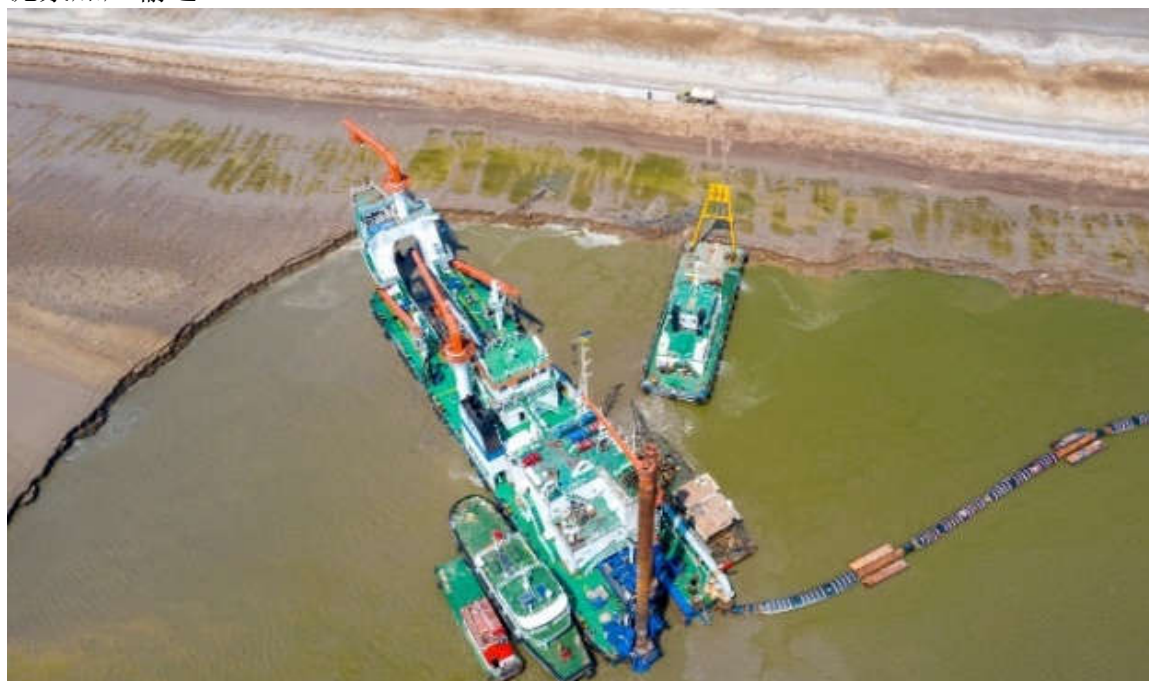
绞吸式挖泥船绞吸施工示意图
